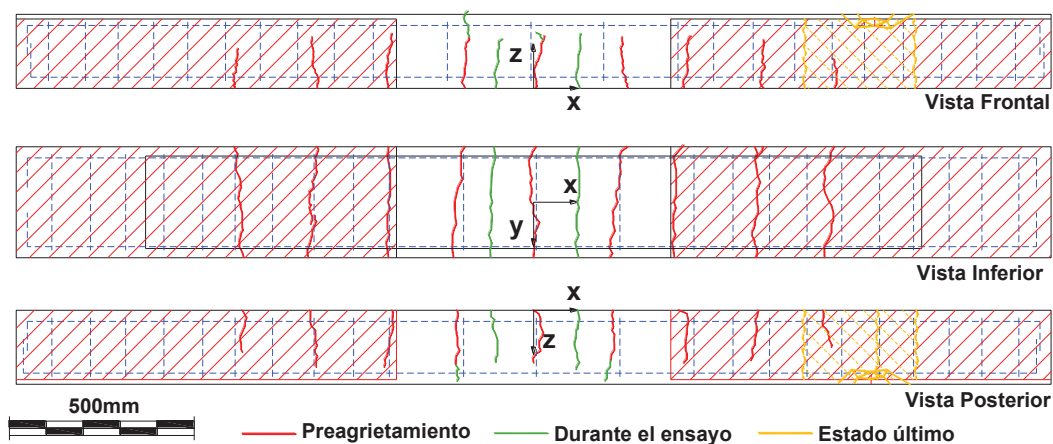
Esquema del patrón de agrietamiento de la viga 3C durante el ensayo por carga última.
